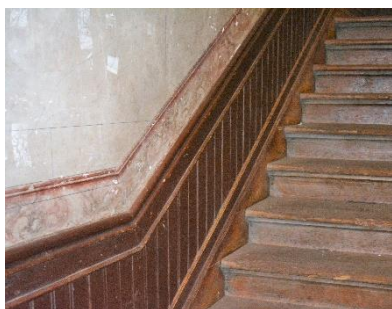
Revestimento em madeira; Friso na parede; Piso 0
